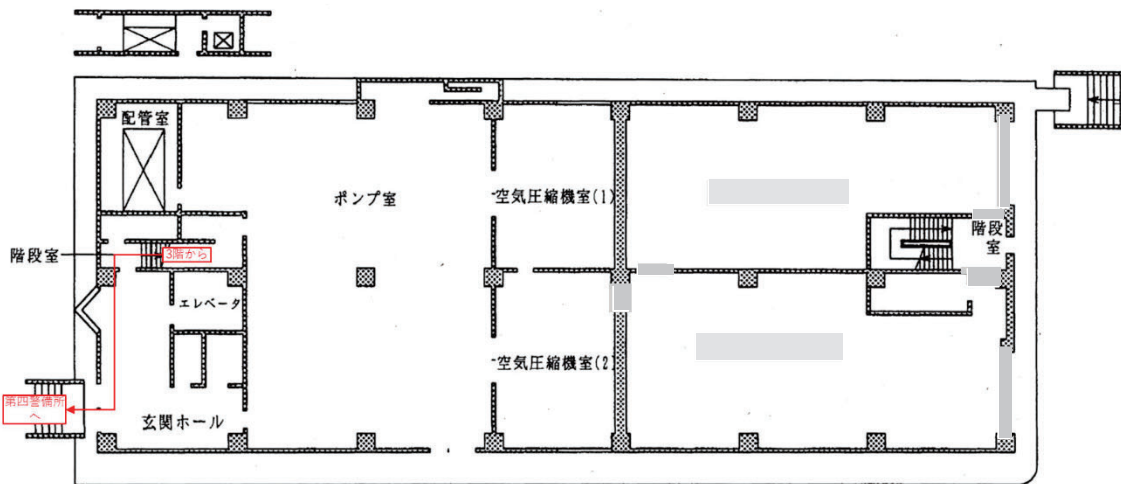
(2) 移動経路 (ユーティリティ施設 地上1F 平面図)
